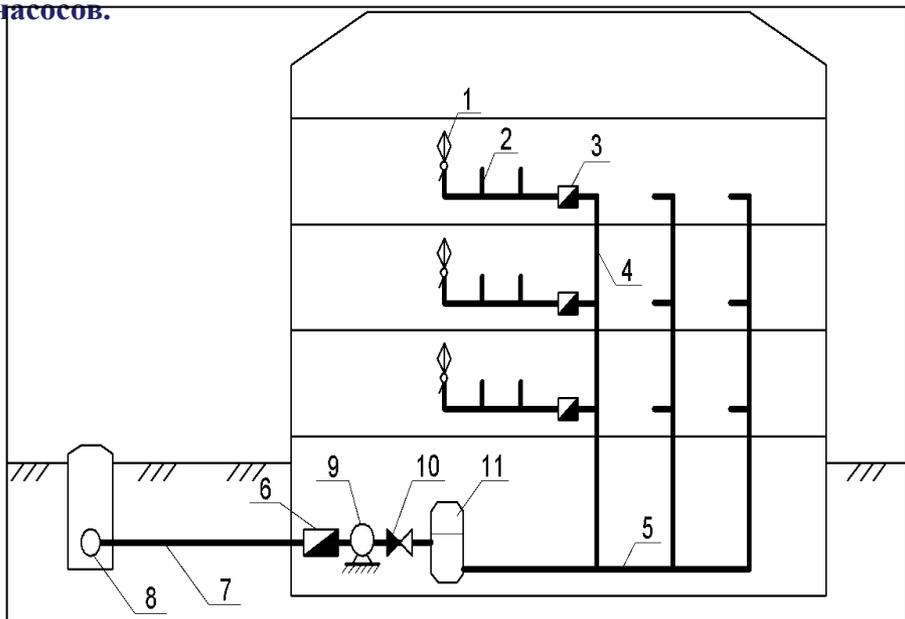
Схема водоснабжения здания с местной насосной установкой и гидропневматическим баком:
